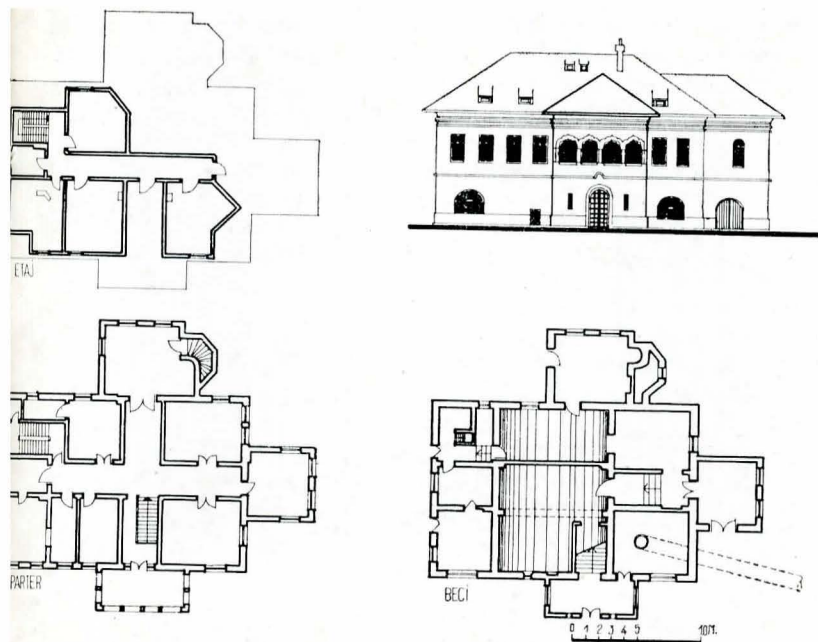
b. Conacul Cantacuzino din Rîfov (plan beci, plan parter, plan etaj și fațadă).
